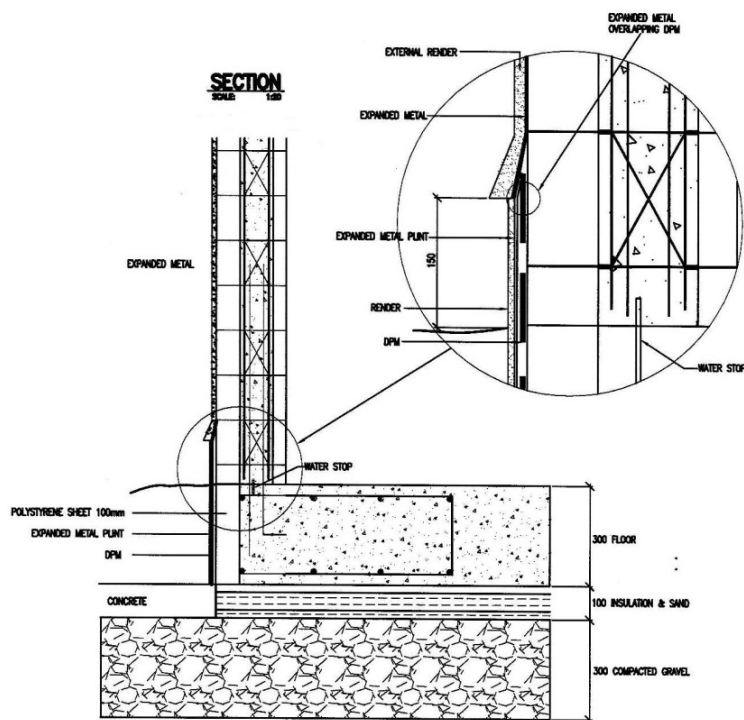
coupe verticale de liaison PLASTBAU-3 (r) et hourdis
